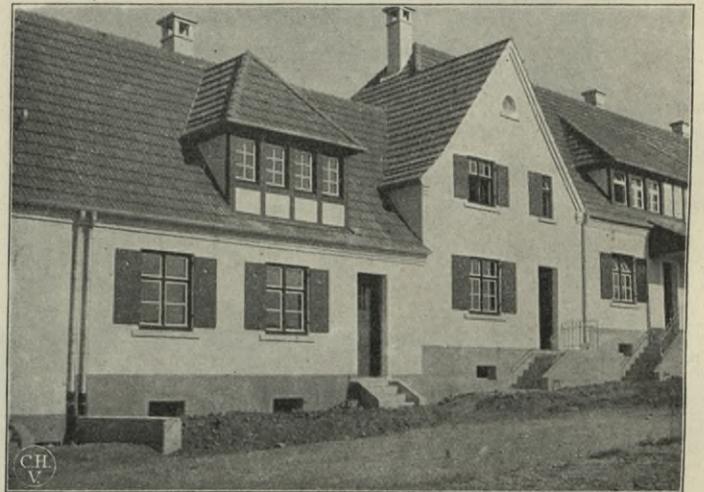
Reihenhäuser in Ulm. Architekt Stadtbaurat Holch
